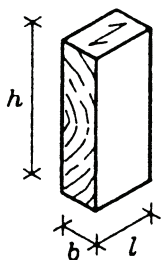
Prüfkörper aus Bauholz für tragende Zwecke
